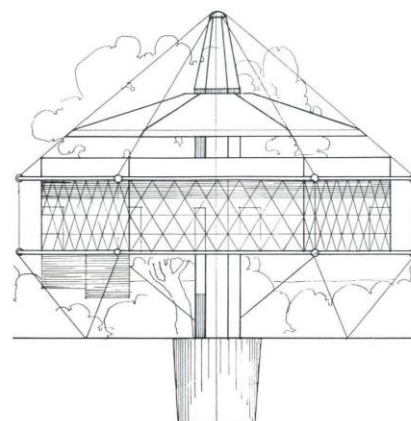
Alzado Dymaxion House, fase proyecto. Buckminster Fuller, R., 1929.
